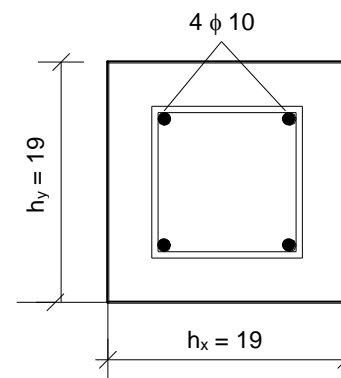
Detalhamento da armadura na seção transversal do pilar P6.
